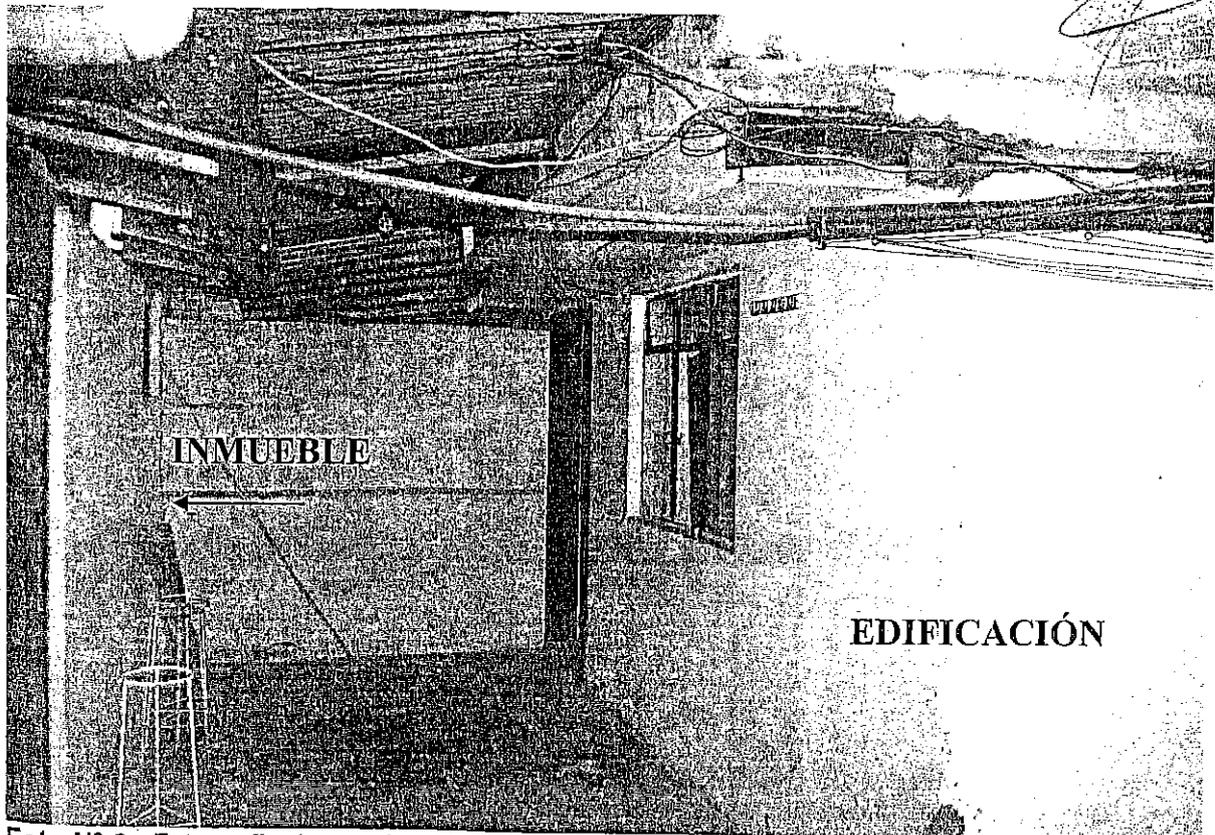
Fotografía de semi-conjunto, en la que se aprecia la primera planta del inmueble y de la edificación.
